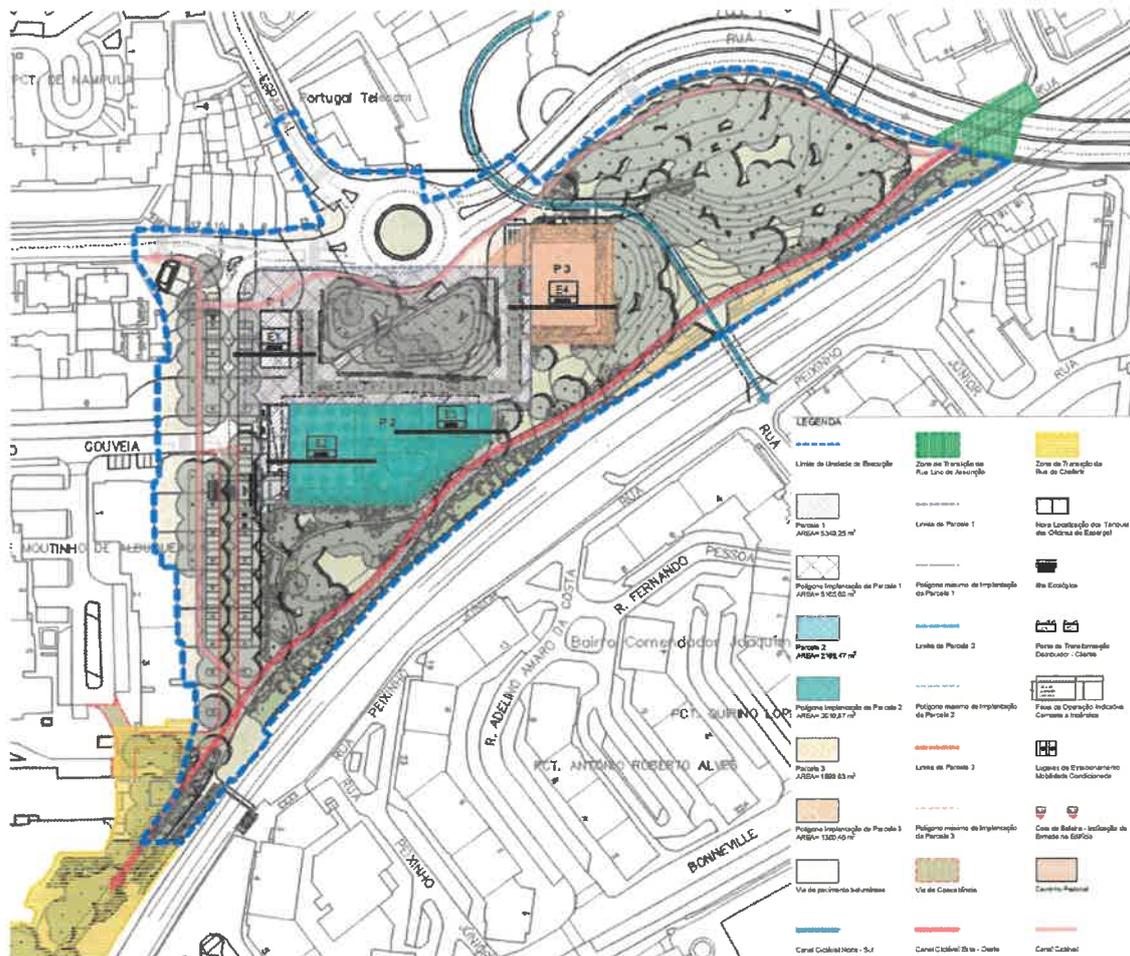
Planta Síntese da Unidade de Execução Espargal.
